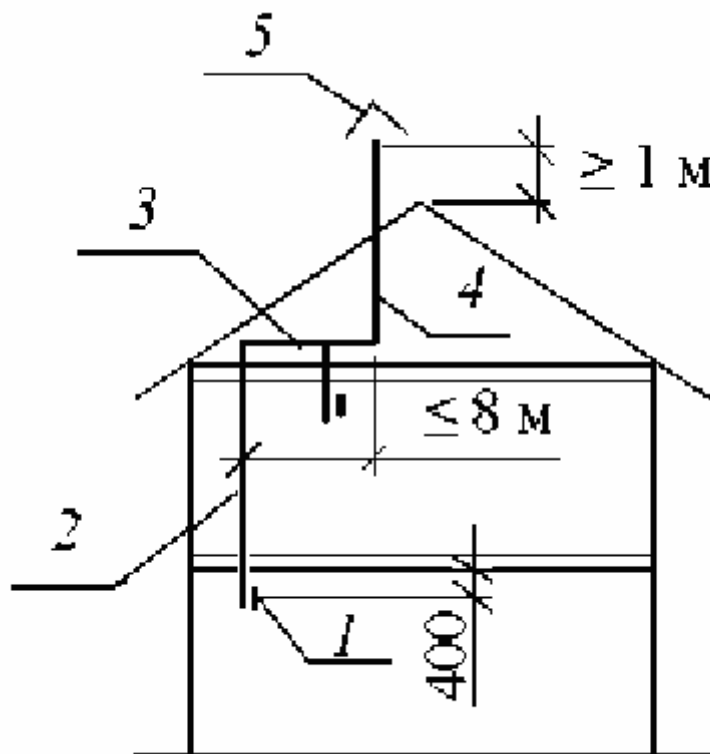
Система вытяжной естественной канальной вентиляции малоэтажного здания
